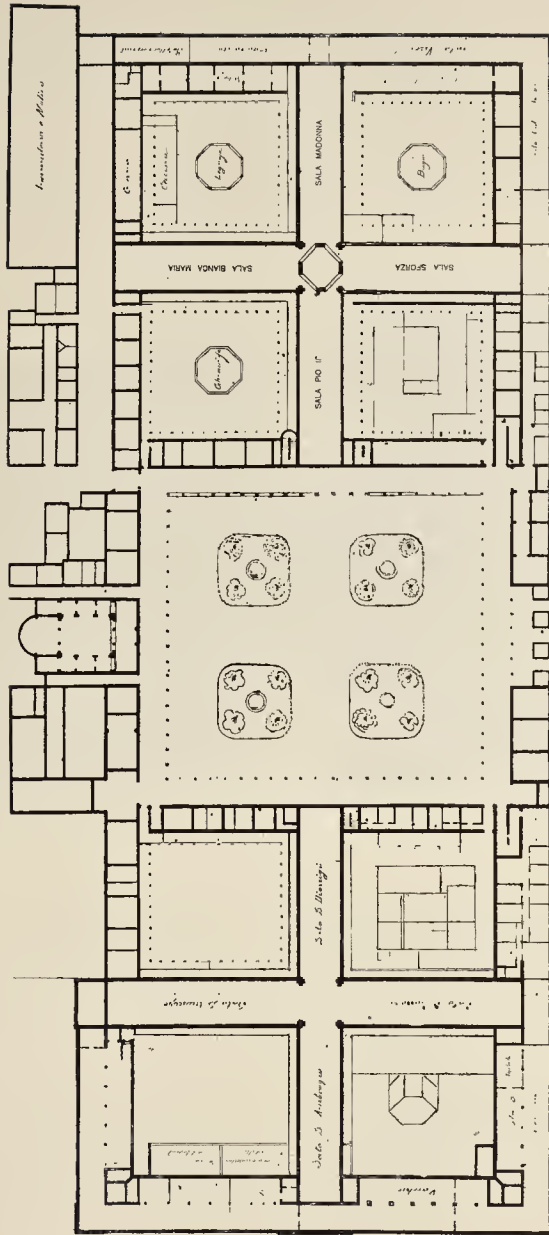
Milano, Ospedale Maggiore. Planimetria del piano terreno (stato attuale)
